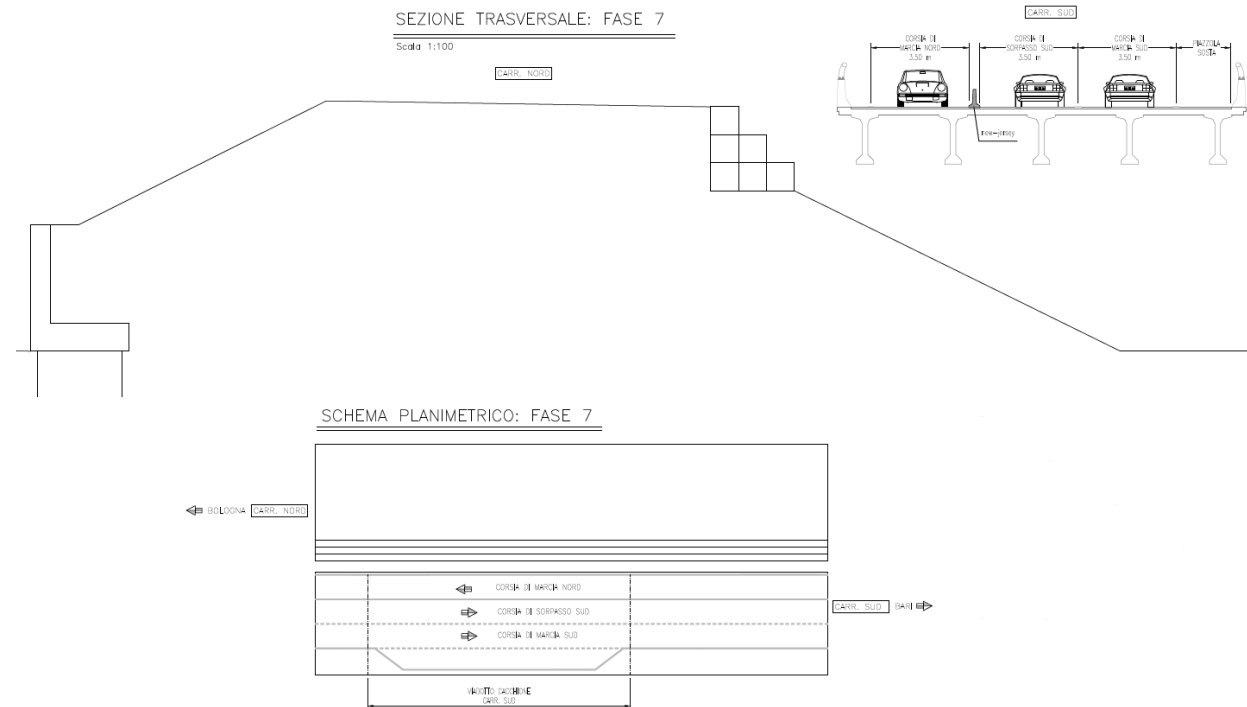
Sezione trasversale e schema planimetrico: Fase 7
